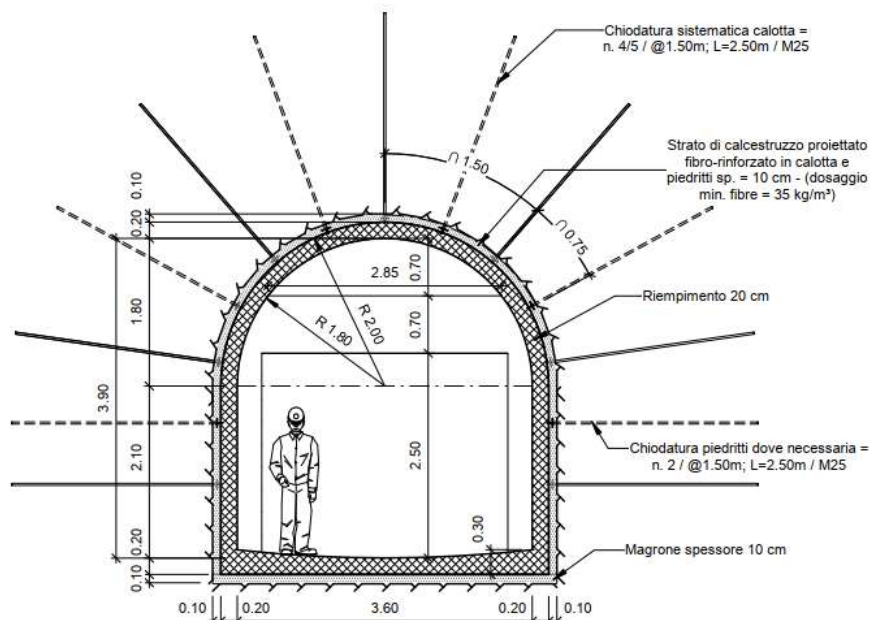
Sezione tipo di rivestimento della galleria di collegamento
